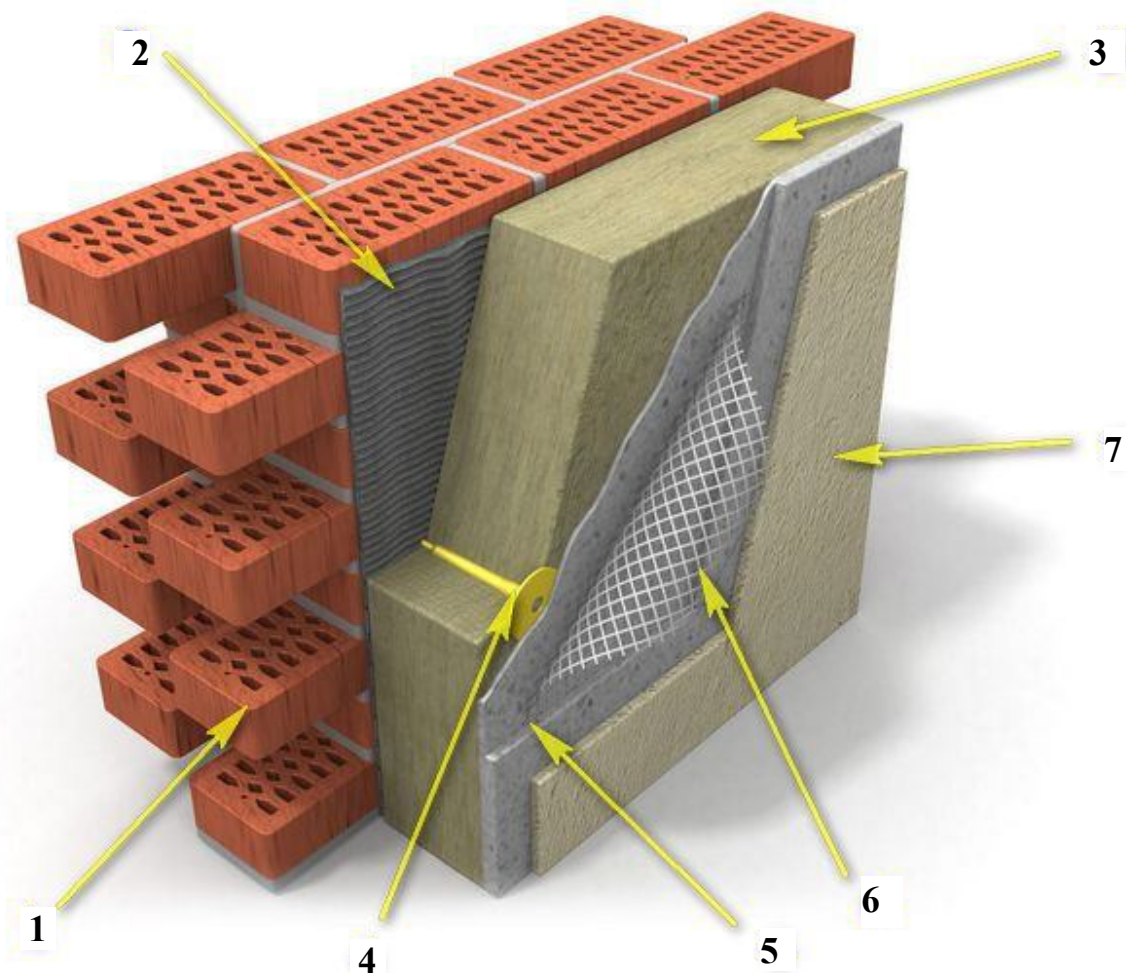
Фасадна система: 1 – несуча стіна; 2 – шар будівельної клейової суміші; 3 – утеплювальні плити мінерального (базальтова вата) походження; 4 – додаткове механічне прикріплення термоізолювального шару – дюбелі-«грибки»; 5 – захисний і вирівнювальний тинькувальний шар; 6 – армувальна сітка; 7 – декоративне тинькування фасаду
